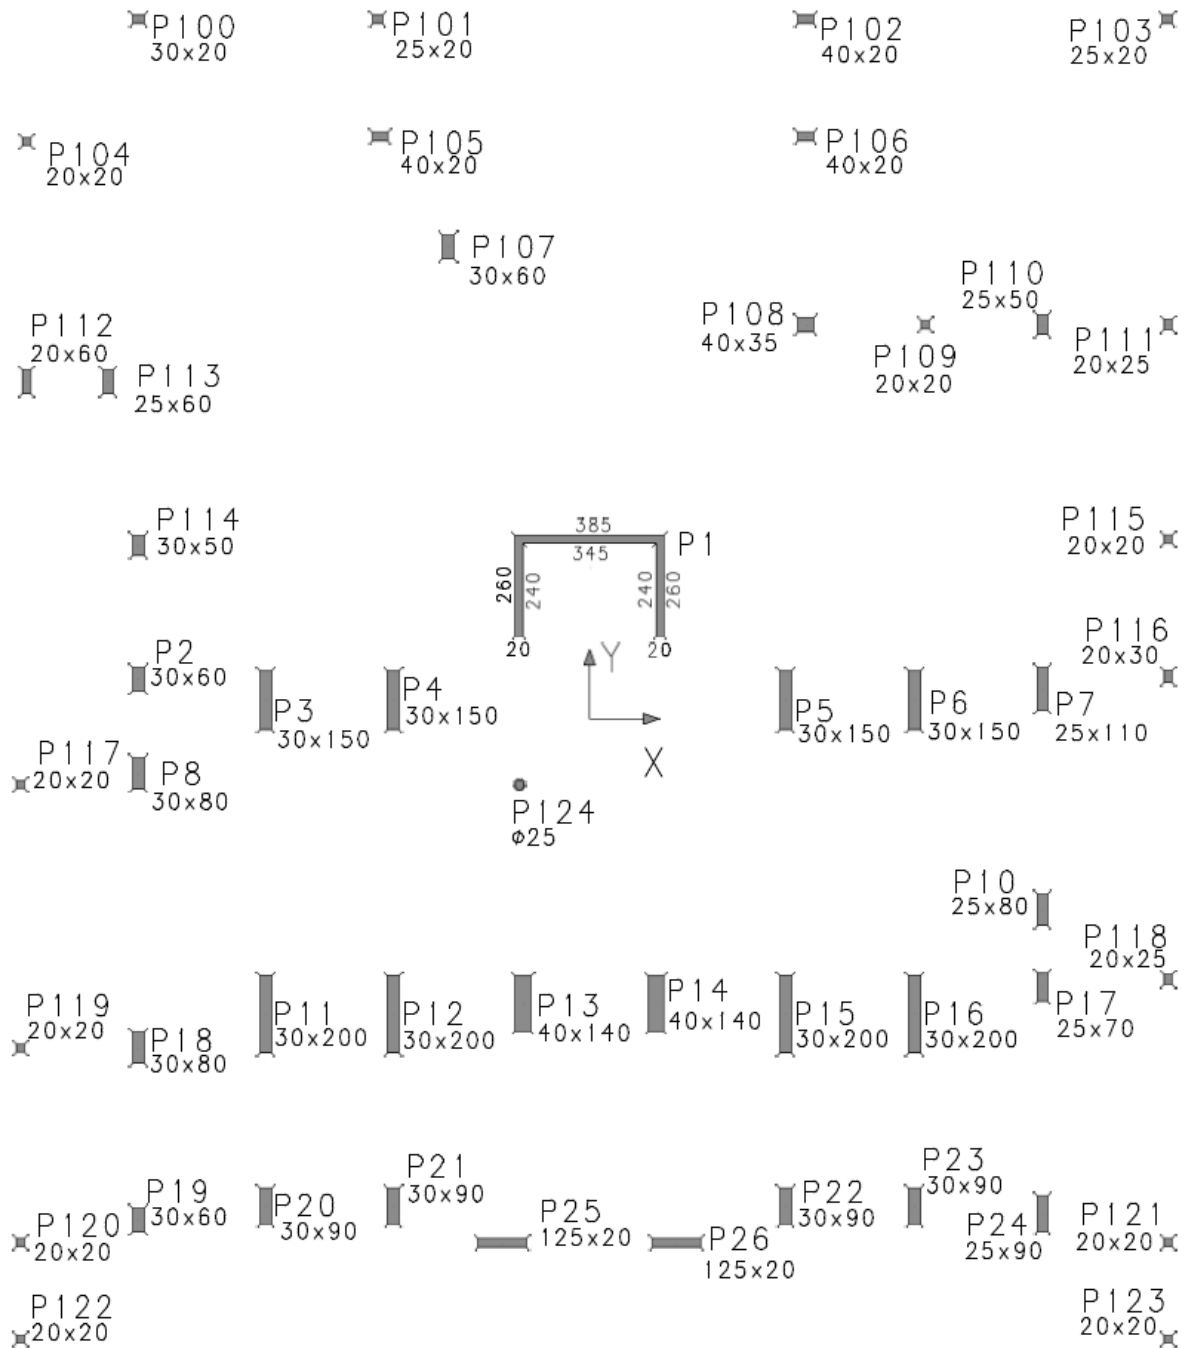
Planta de localização dos centros de carga dos pilares na fundação.
